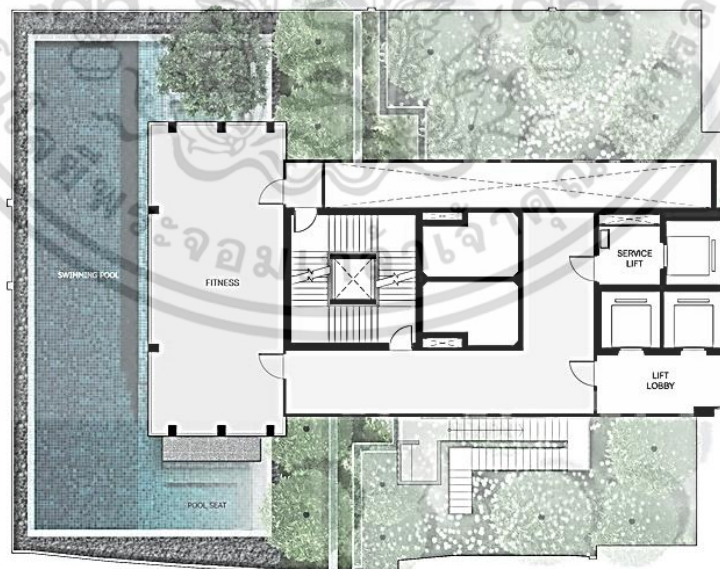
ผังโครงการ The Monument ชั้น 22
